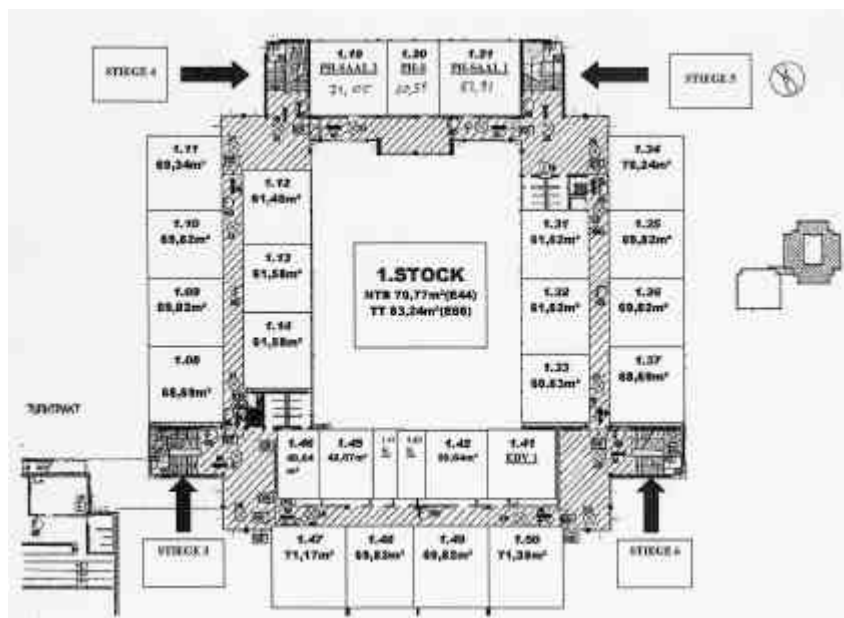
1. Stock des Schulgebäudes im Grundriss
